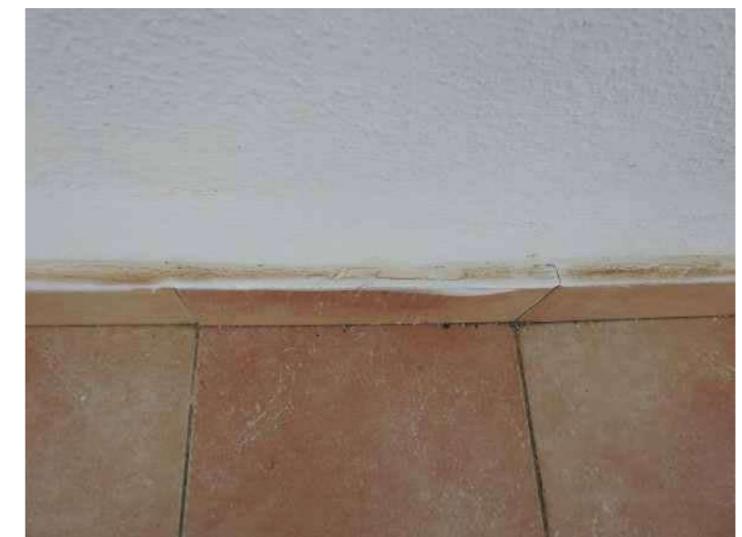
Vista dettagliata dei segni di distacco del battiscopa lungo il parapetto di Foto N°35 di entità, allo stato, ancora capillare
